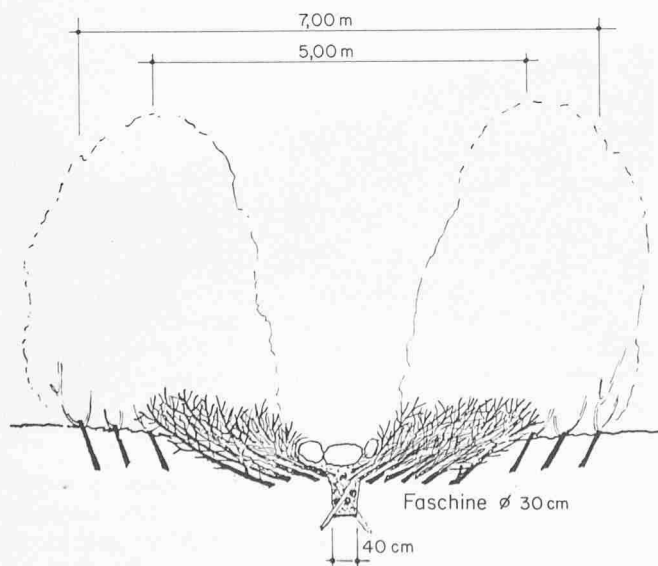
Lebende Tropfzangen zur Ableitung des Wassers aus Brückenbauwerken
